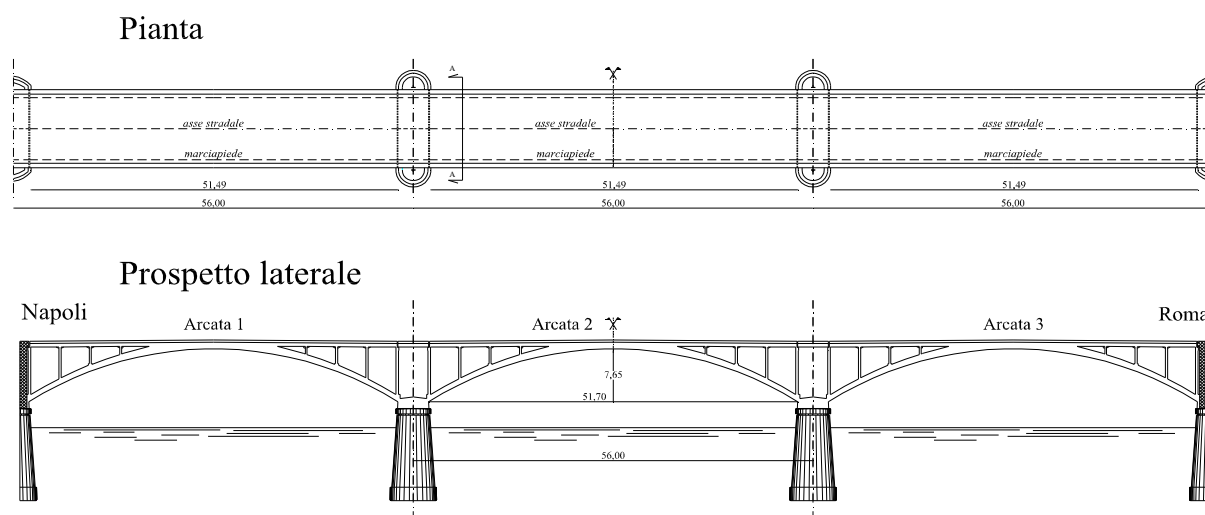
Geometria del ponte (pianta e prospetto laterale lato monte).
